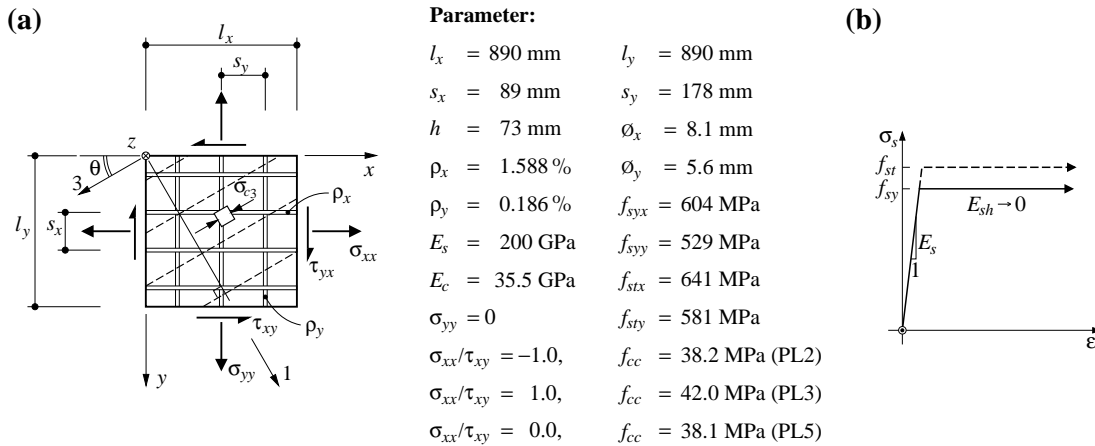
Stahlbeton-Scheibenversuche [Xie et al. (2011)]: (a) Scheibenelement mit Bezeichnungen und Parametern; (b) Idealisierte Werkstoffbeziehung für den Betonstahl.
